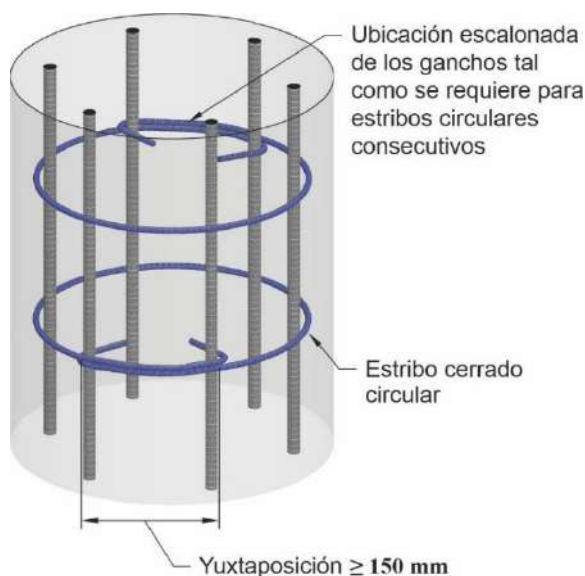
Anclaje de estribos circulares.
